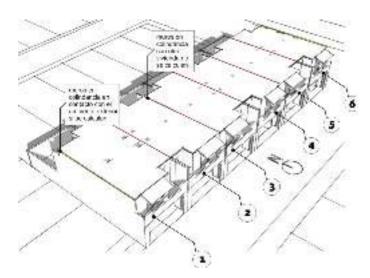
Perspectiva viviendas en conjunto horizontal.
